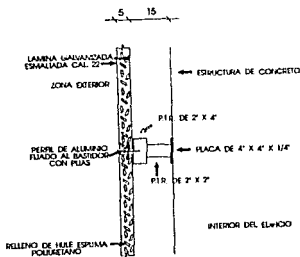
DETALLE DE PANEL EN FACHADAS
